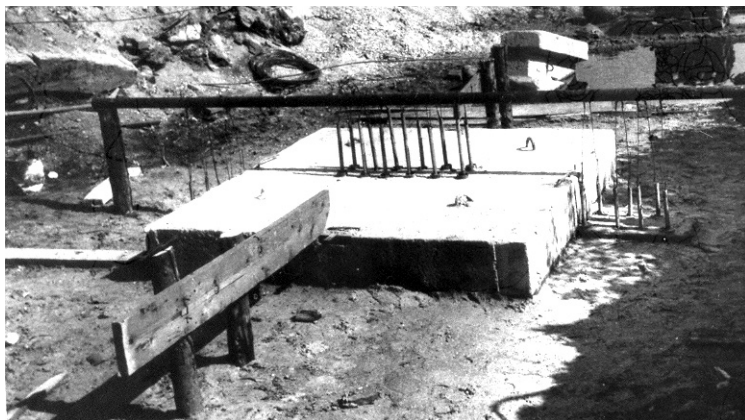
Общий вид фундамента площадью 4 м<sup>2</sup> с установленными грунтовыми марками и реперными системами подготовленного к загрузке
